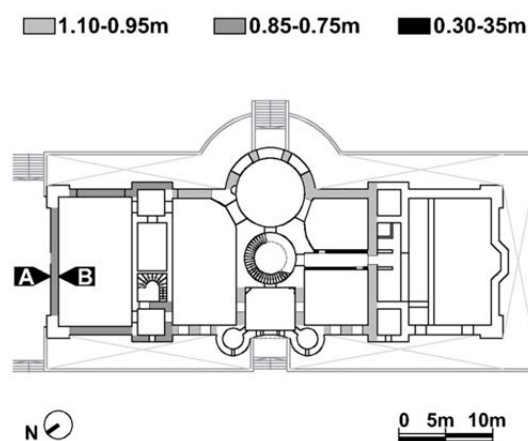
Planta baja del castillo Dalquharran con indicación de los distintos espesores de muro identificados in situ. A y B definen la posición de las imágenes de 1m² fotografiadas a nivel de planta baja.
